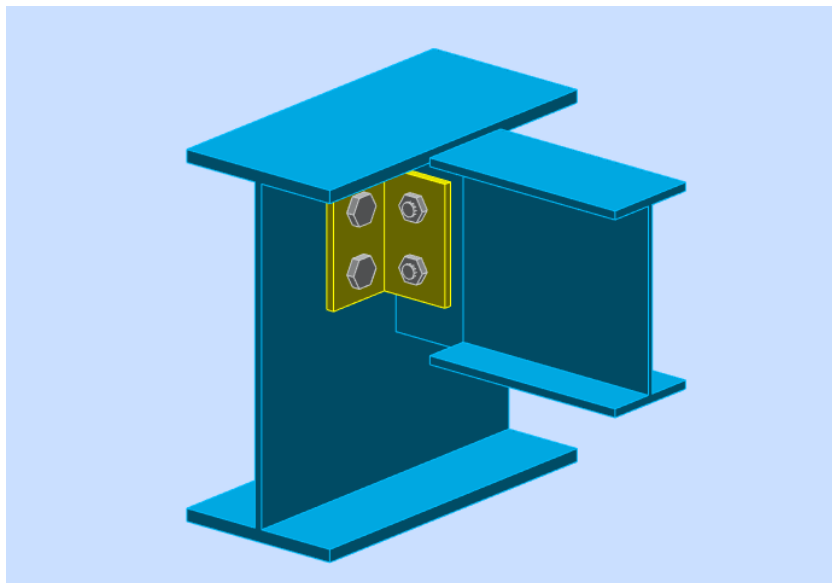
Vue de l'assemblage solive - poutre sur Robot
